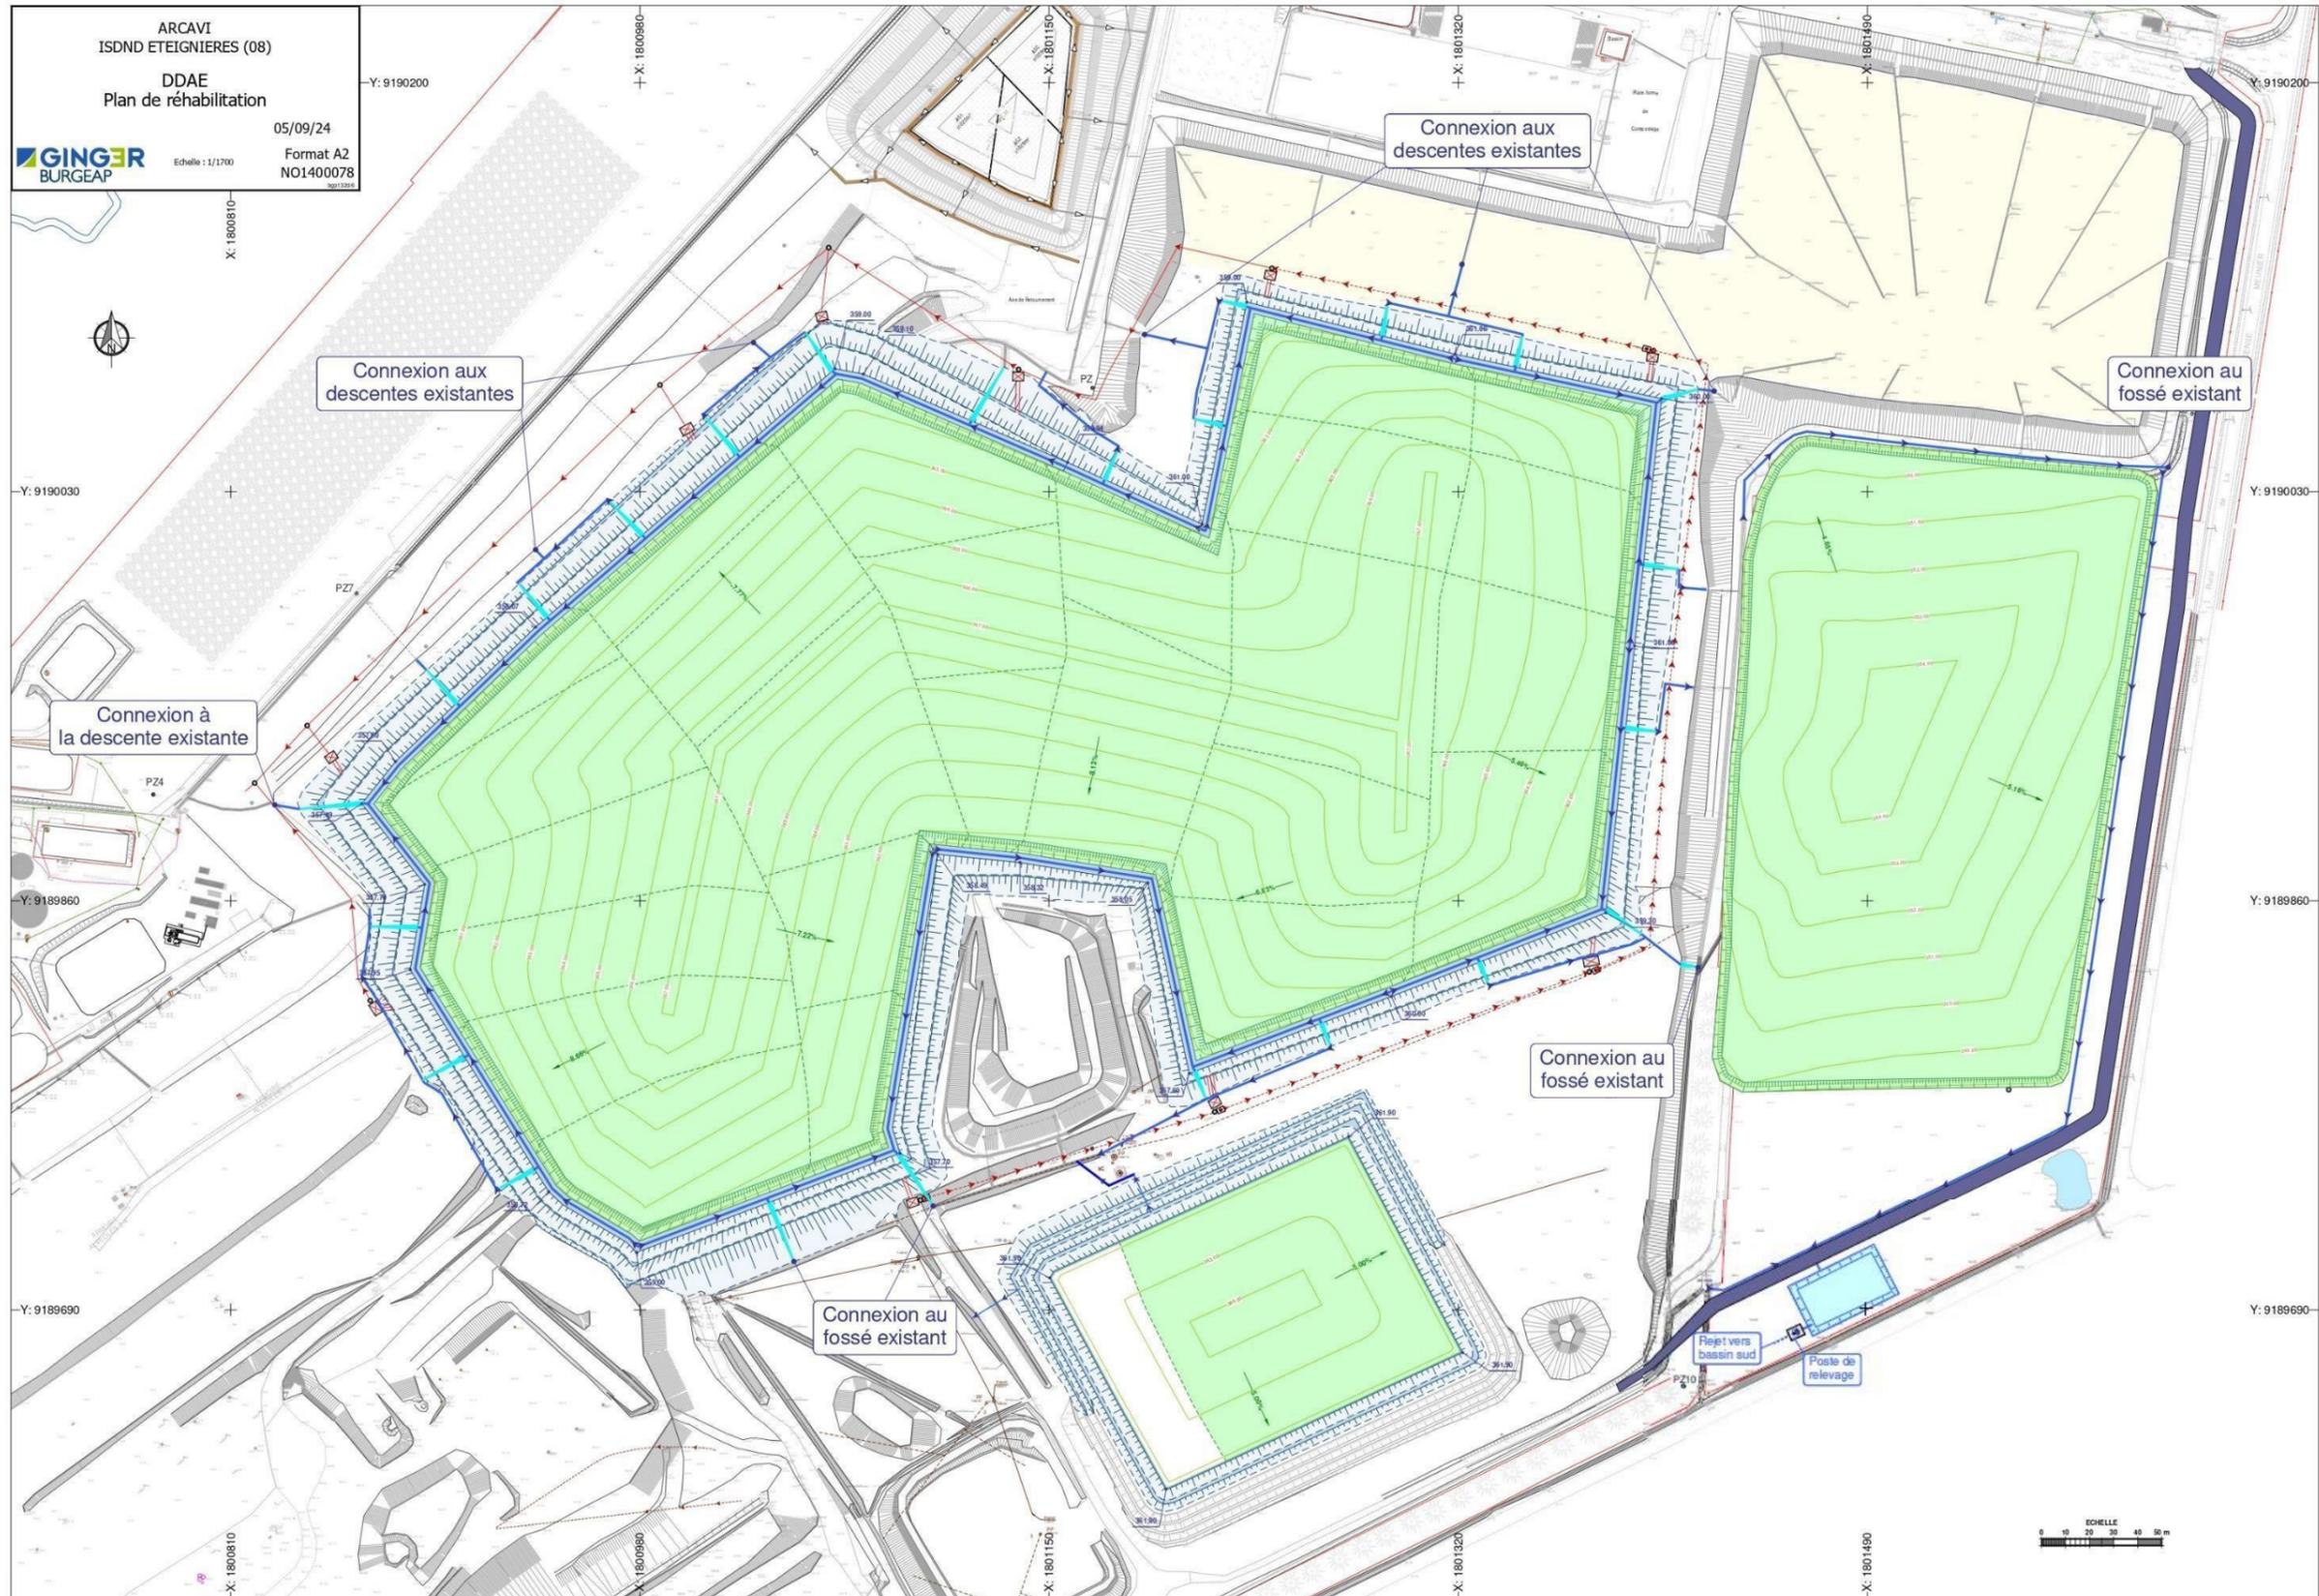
Plan de réaménagement du site (source : GINGER BURGEAP)
